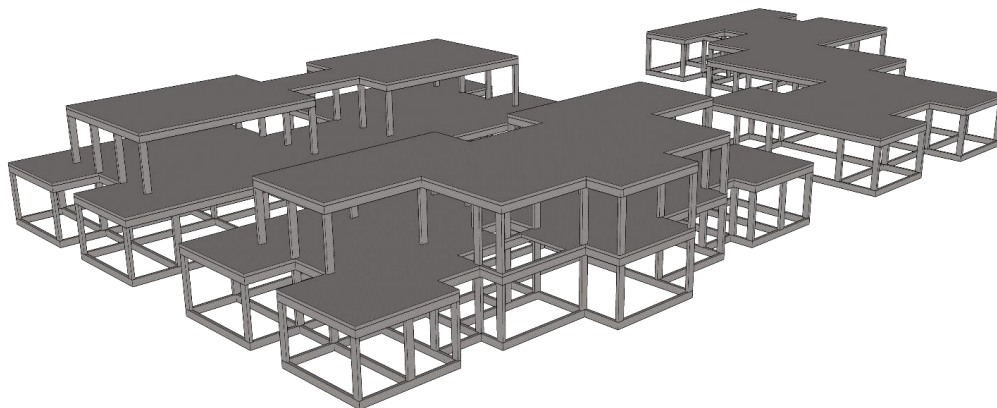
MODULAÇÃO ESTRUTURAL. FONTE: AUTORAL.
